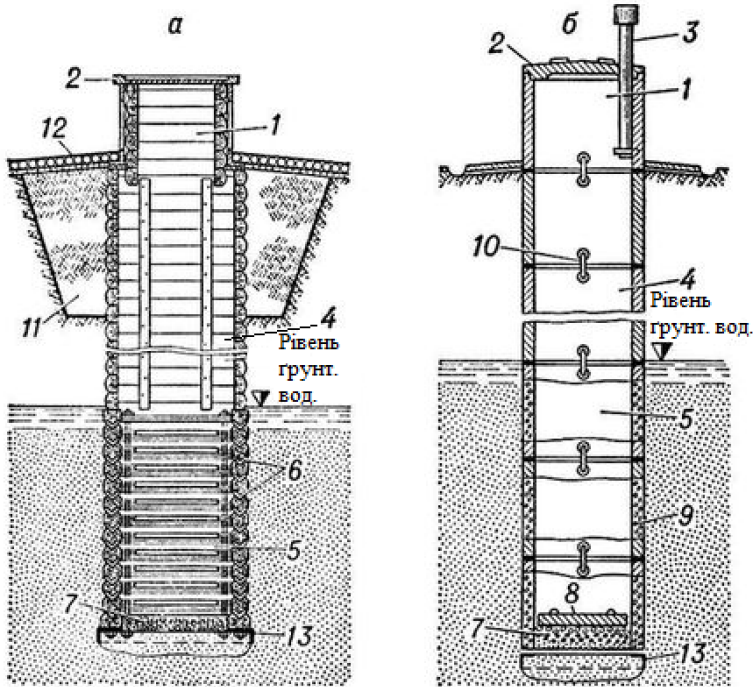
Зрубовий шахтний колодязь з гравітаційним фільтром (а) і залізобетонний з водоприймальною частиною з дірчастого бетону (б); 1 – оголовок; 2 – кришка; 3 – вентиляційна труба; 4 – ствол (частина шахти від поверхні землі до водоносного шару); 5 – водоприймальна частина шахти; 6 – гравітаційний фільтр (у V-подібних отворах); 7 – донний фільтр; 8 – плита з дірчастого бетону; 9 – стінки з дірчастого бетону; 10 – скоби, які скріплюють плити; 11 – замок з глини; 12 – відмостка; 13 – ніж (залізна пластина)
